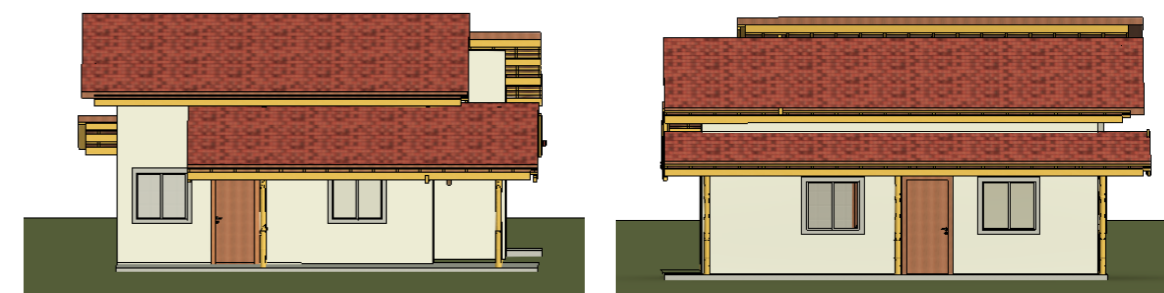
Fachadas frontal (a) e posterior (b) da habitação. Fonte: elaborado pelos autores.
